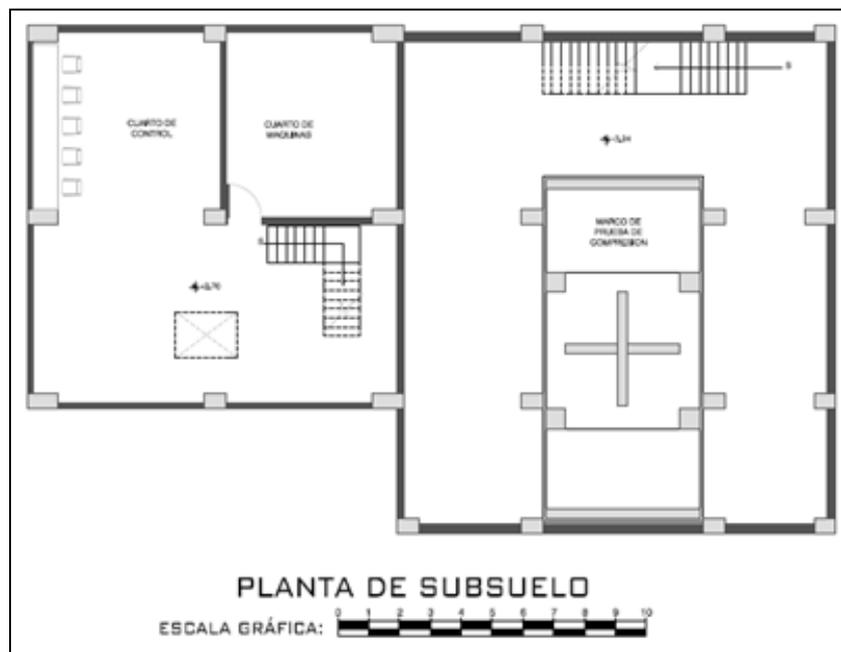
Planta Arquitectónica de Subsuelo de la carrera de ingeniería civil
